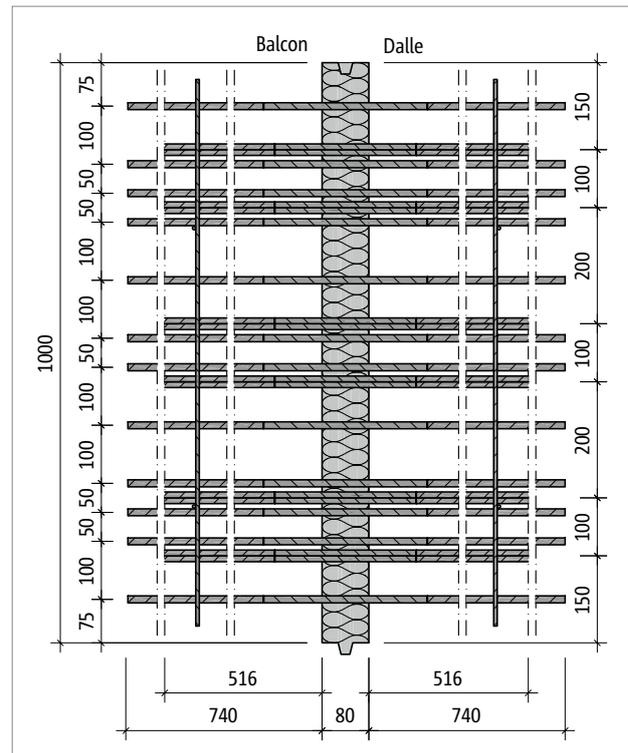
Schöck Rutherma® T type D-MM5-VV3 : vue en plan
